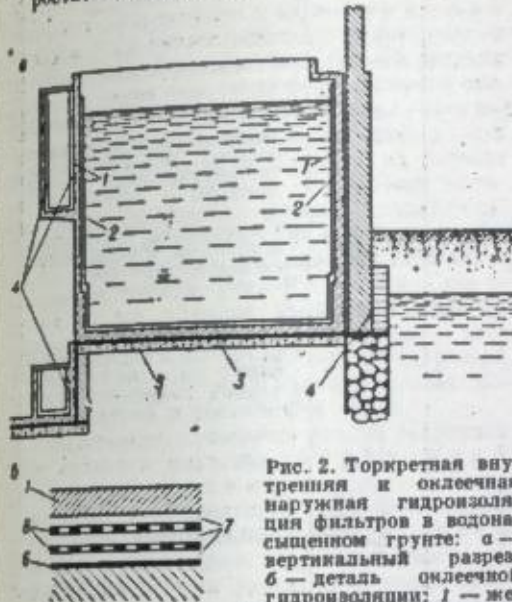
Торкретная внутренняя и оклеечная наружная гидроизоляция фильтров в водонасыщенном грунте: а — вертикальный разрез; б — деталь оклеечной гидроизоляции; 1 — железобетонная конструкция; 2 — слой торкрета внутренней изоляции; 3 — оклеечная наружная изоляция; 4 — защитная стенка; 5 — защитный слой; 6 — грунтовка; 7 — слой мастики; 8 — рулонный материал.
